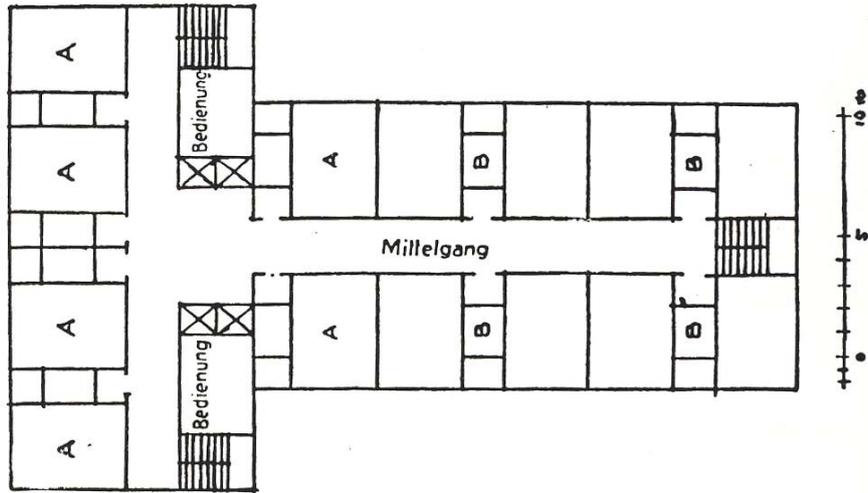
Ludwig Hilberseimer, Grundriss für ein Apartment-Haus, 1929
